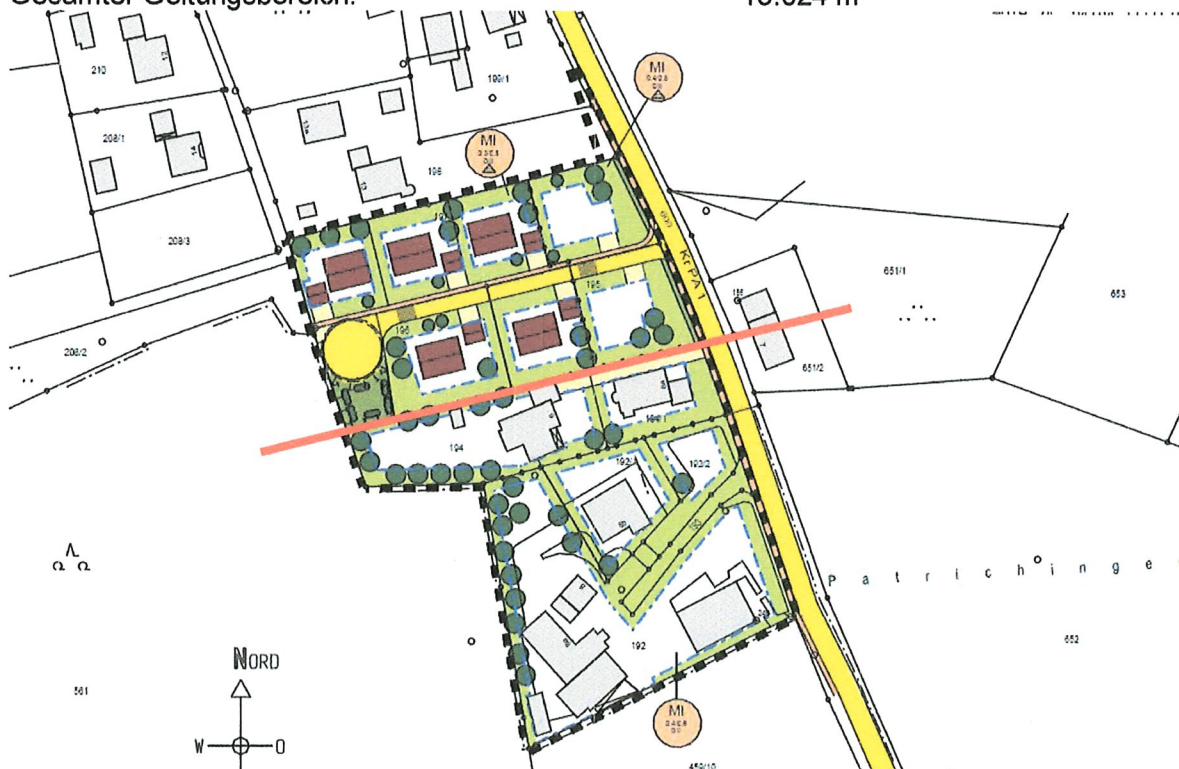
BBP mit Planung (oberhalb der roten Linie) und Bestand (unterhalb)
